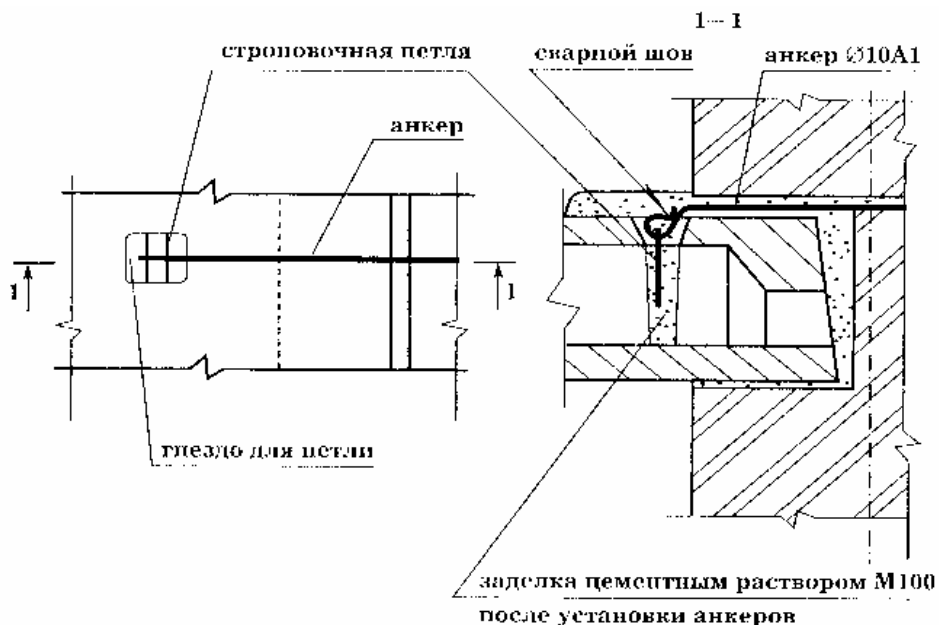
Анкеровка плит перекрытий с утопленными петлями
